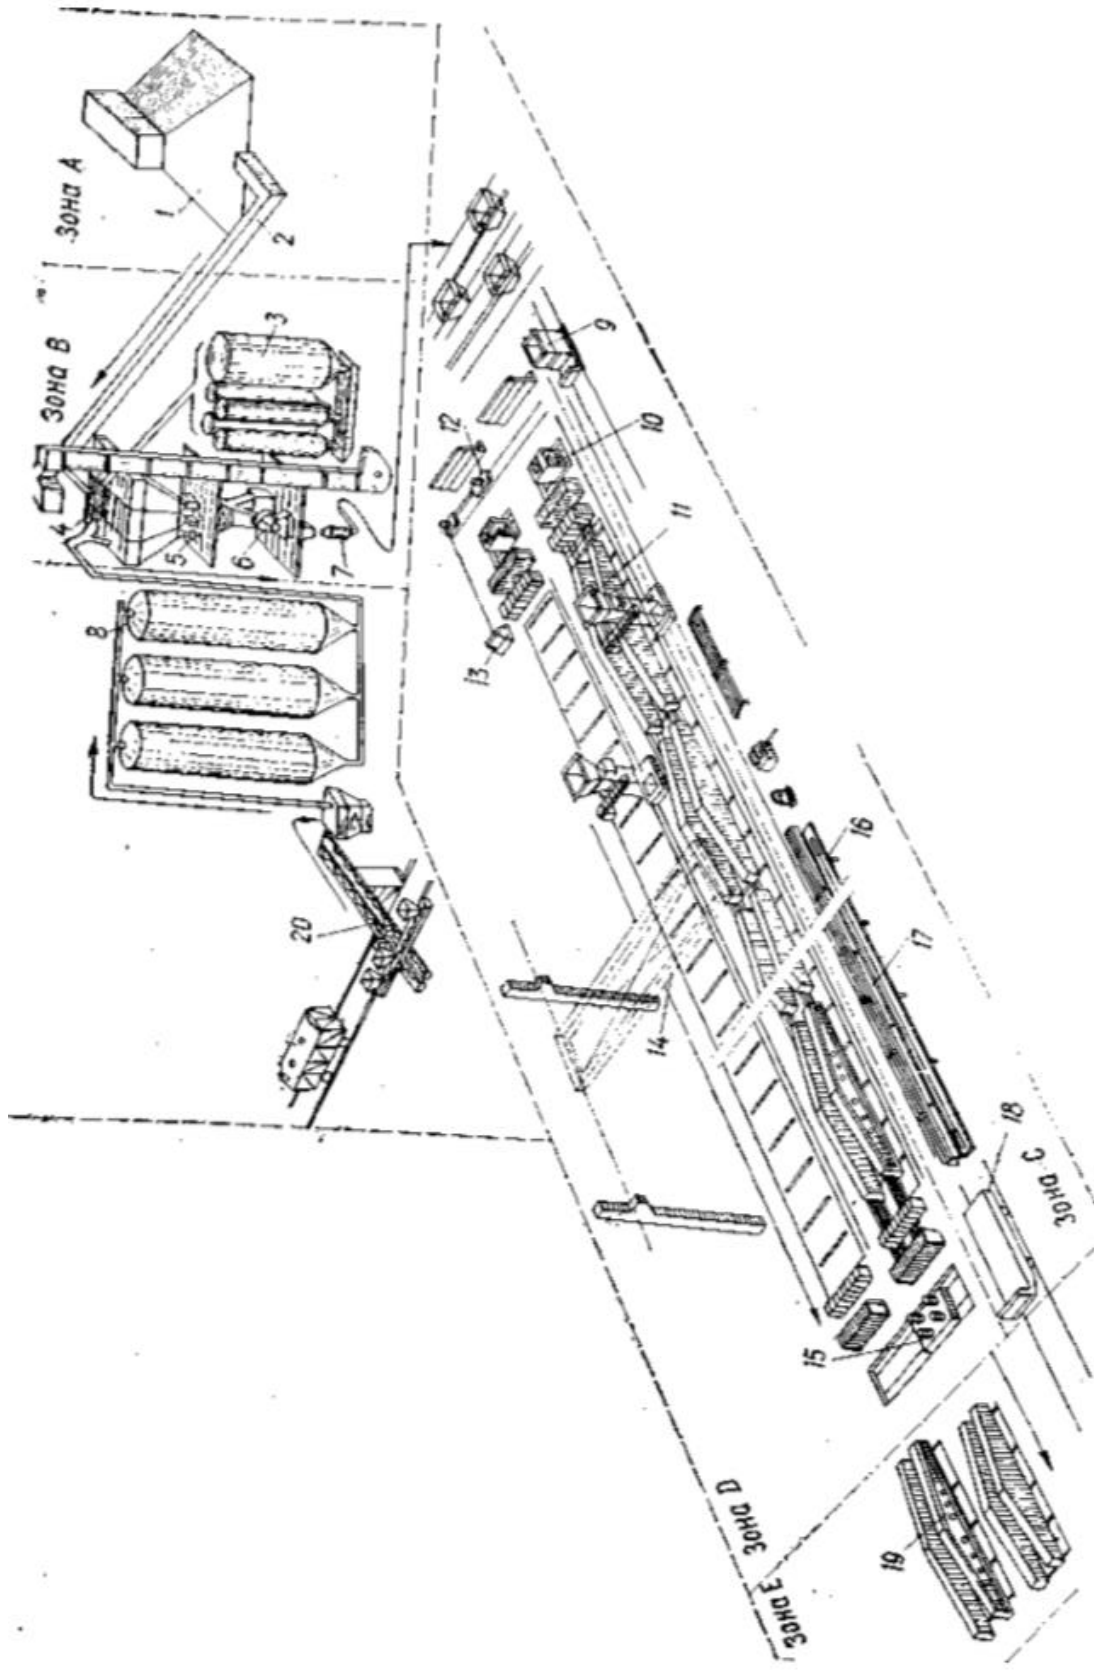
Технологическая схема изготовления железобетонных изделий стендовым способом
